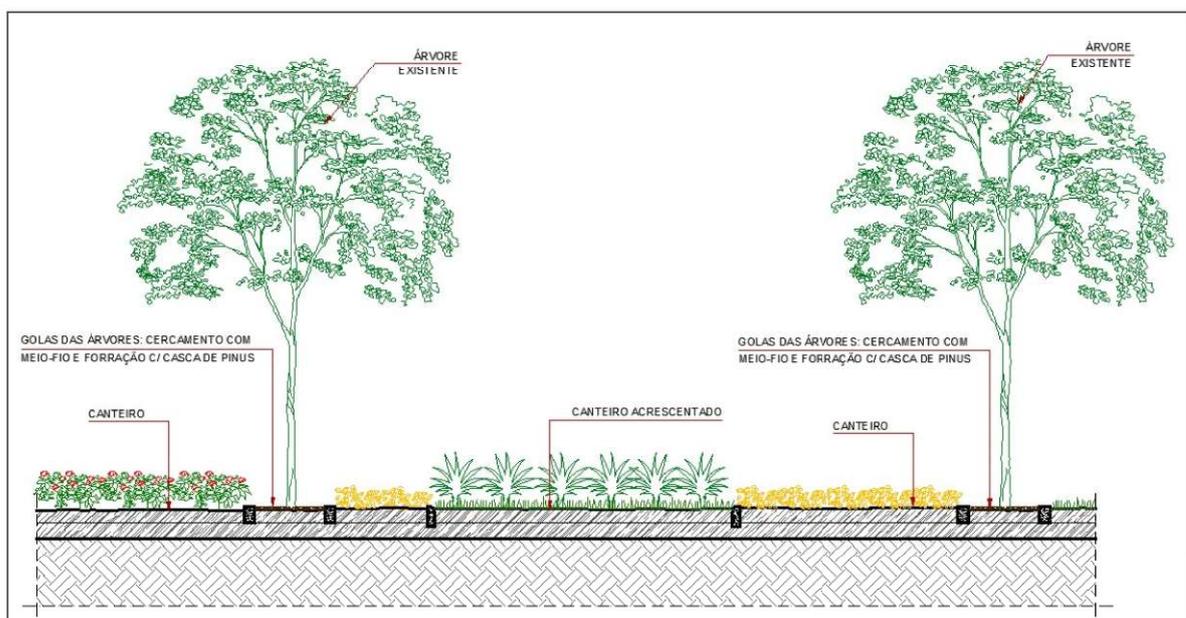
trecho em detalhe (seção longitudinal) de parte do canteiro com a elevação de área cultivada em trecho atualmente rebaixado e utilizado como passagem de pedestres (fonte: Serpenge)
